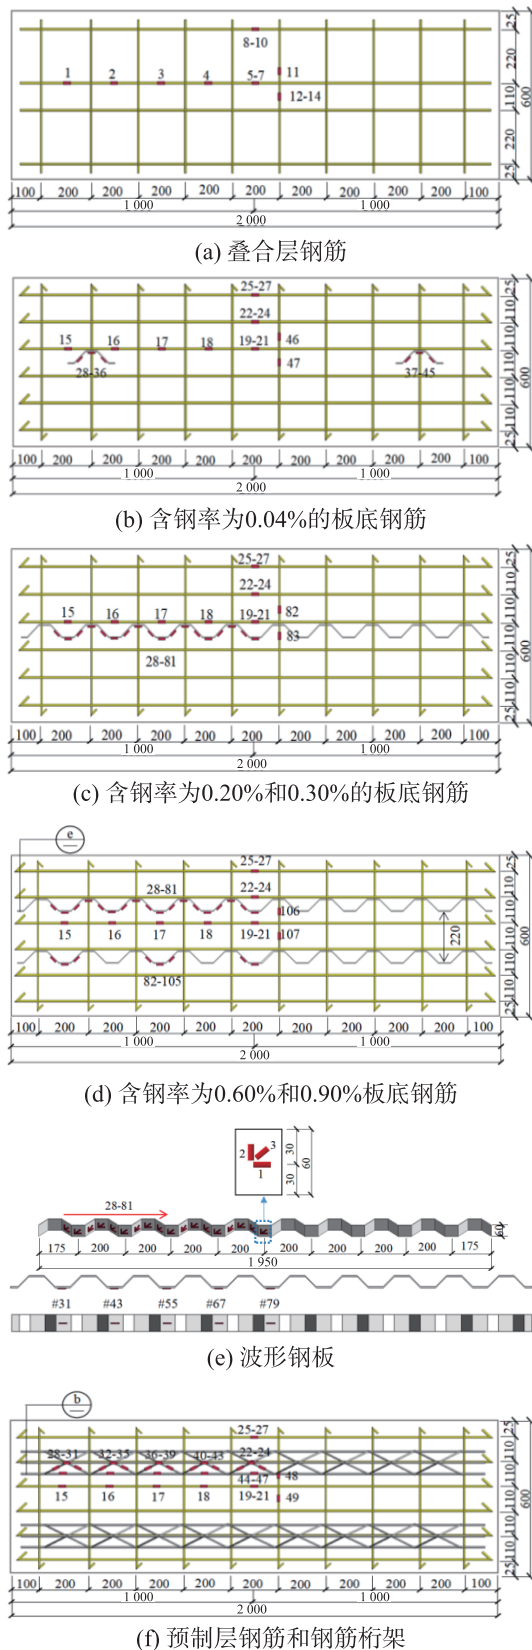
波形钢板、钢筋桁架和钢筋应变片布置示意图 单位:mm
